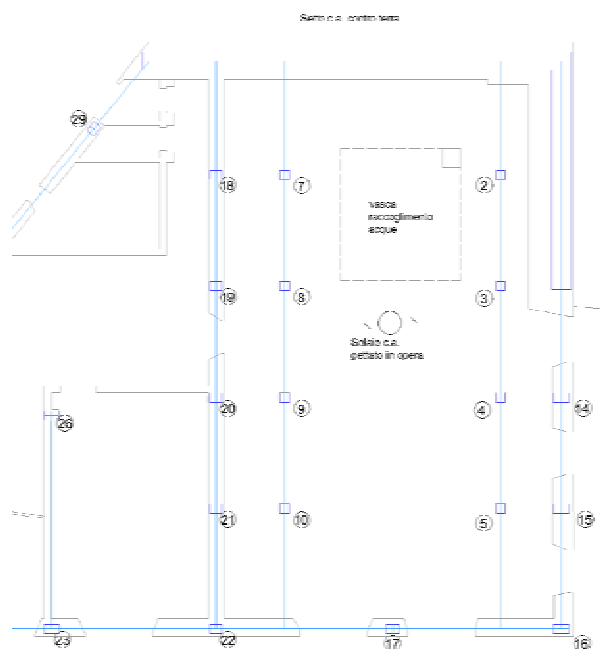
Piano seminterrato cemento armato – vasca di raccoglimento acque
